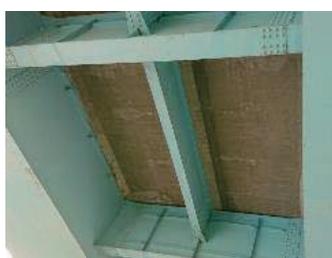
一部の床版で橋軸直角方向のひび割れ・漏水確認
